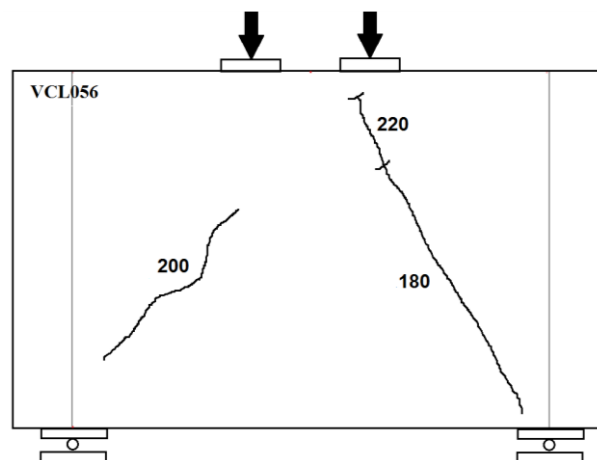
Esquema de fissuração da viga VCL056.
